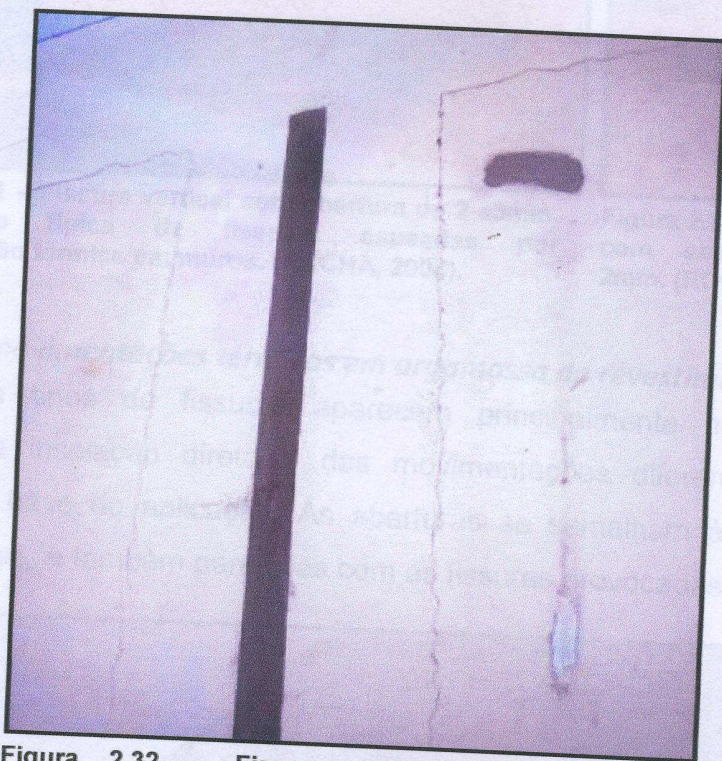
Fissuras verticais causada pela movimentação térmica diferenciada do concreto e alvenaria. (ARQUIVO PESSOAL, 2008).
